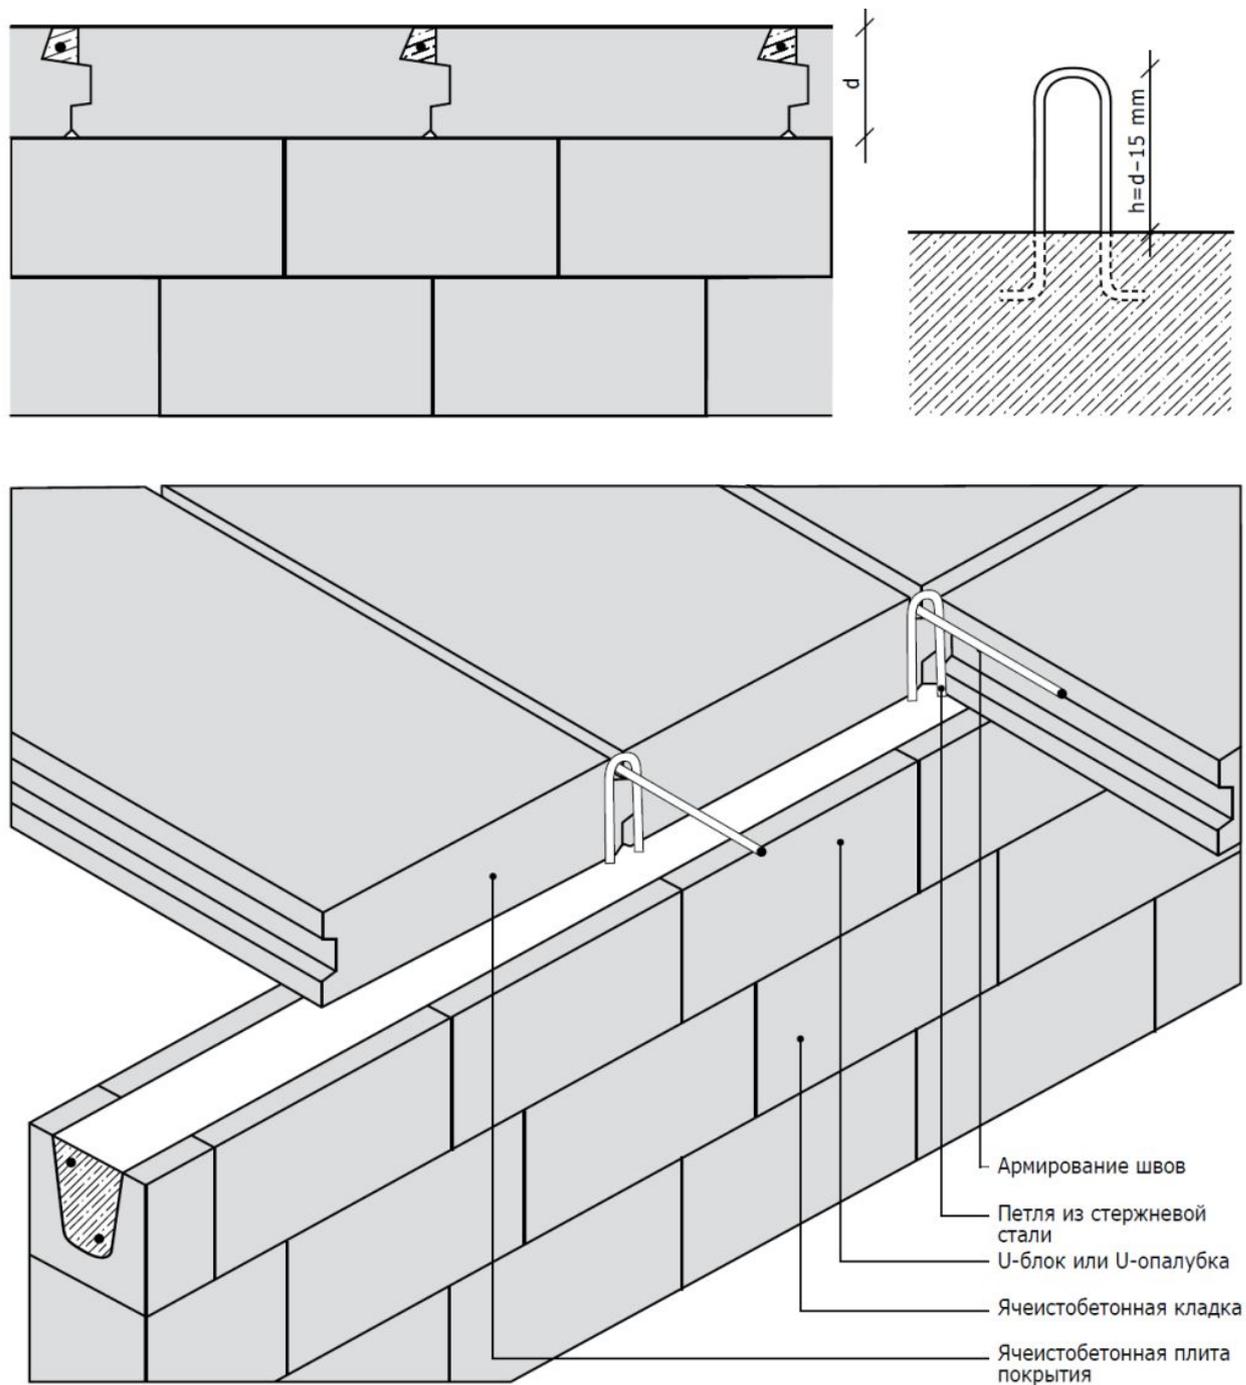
Зона сопряжения стена-перекрытие. Двустороннее опирание панелей перекрытия, обвязочный пояс под перекрытием
